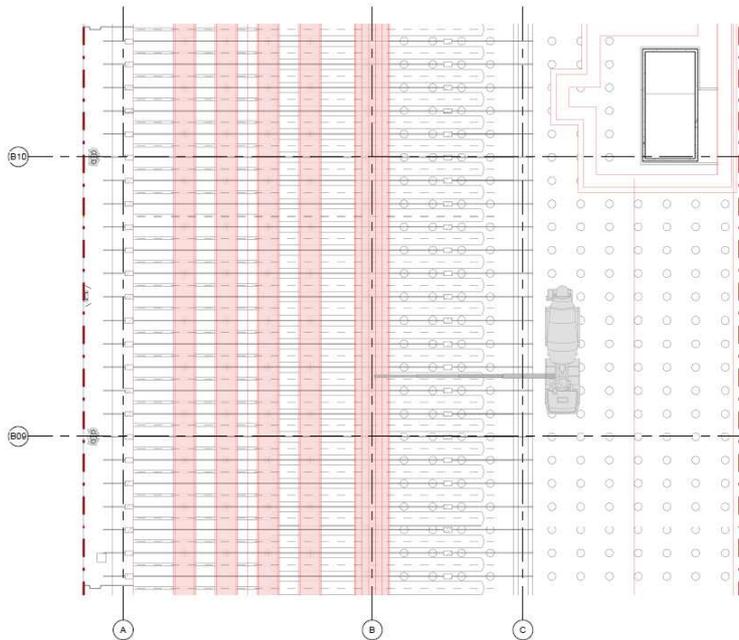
Planimetria con indicazione delle travi in c.a. di progetto
